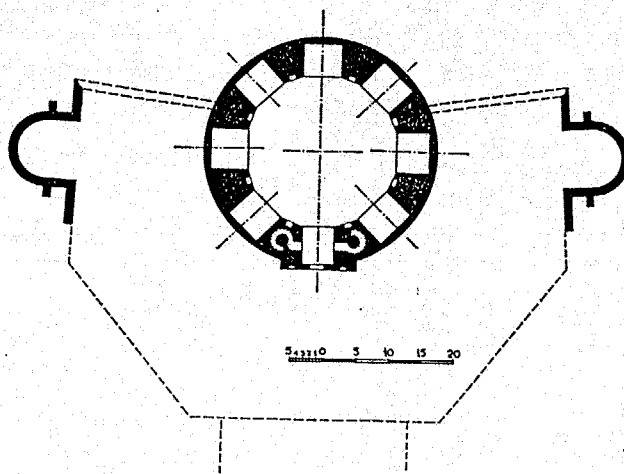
：ロトンダ・ガレリウス帝時代の平面図 (after Pazara)
